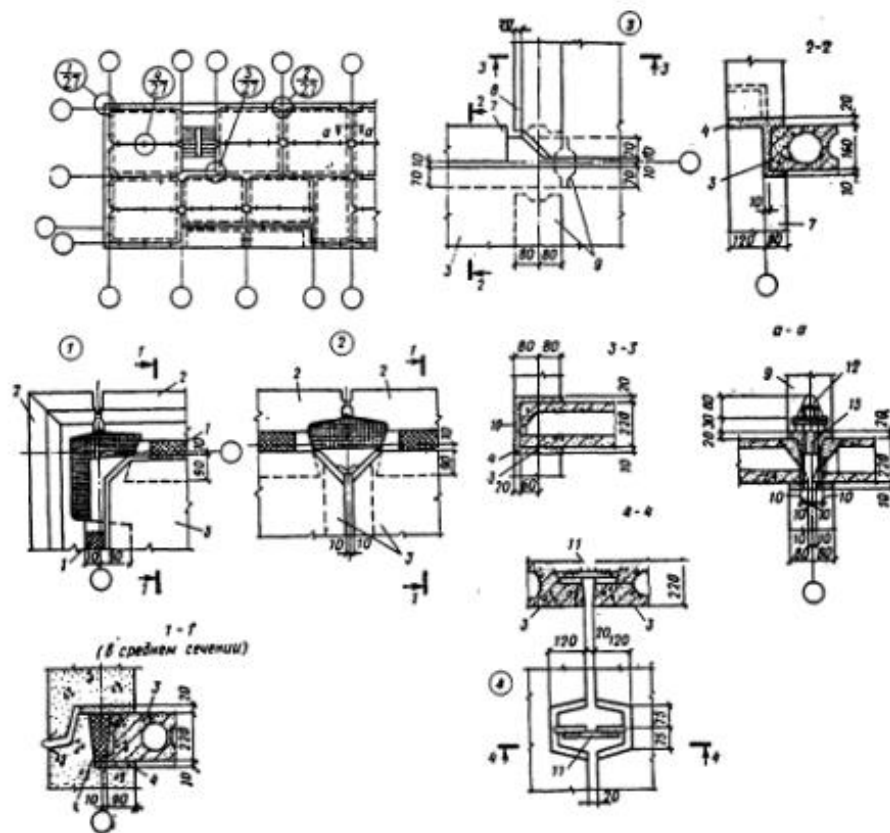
Фрагмент монтажного плана панелей перекрытий в зданиях с «большим» или «смешанным» шагом поперечных стен и узлы сопряжений настилов перекрытий между собой и с панелями стен: 1 — утепляющий вкладыш; 2 — наружная стеновая панель; 3 — панель перекрытия; 4 — цементный раствор; 5 — монтажная петля; 6 — соединительная пластинка; 7 — электропанель; 8 — панель стены лестничной клетки; 9 — панель внутренней стены; 10 — штукатурный раствор; 11 — соединительные стержни; 12 — паз длиной 100 мм; 13 — болт самофиксации осей панелей
